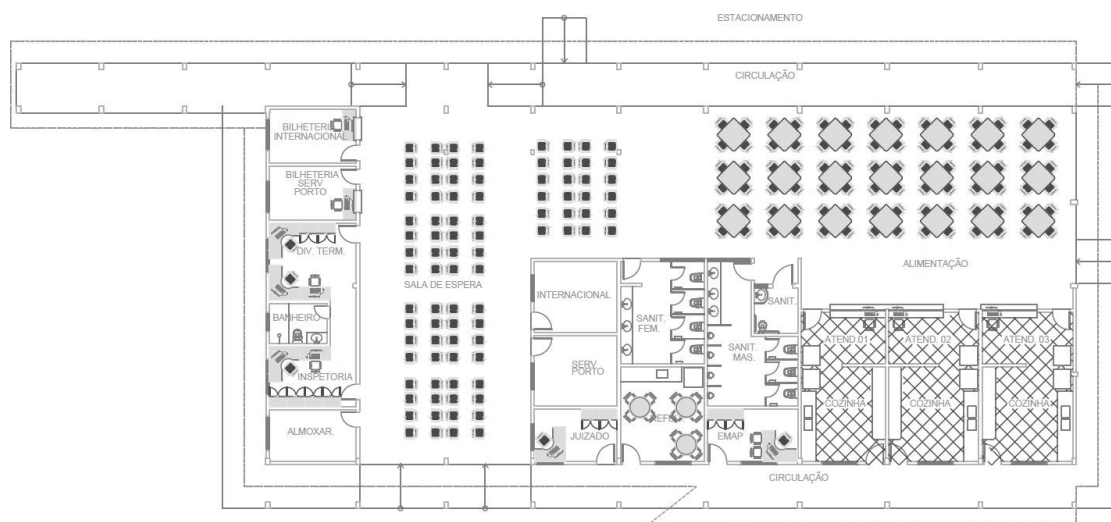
Planta baixa do Terminal de Passageiros da Ponta da Espera
